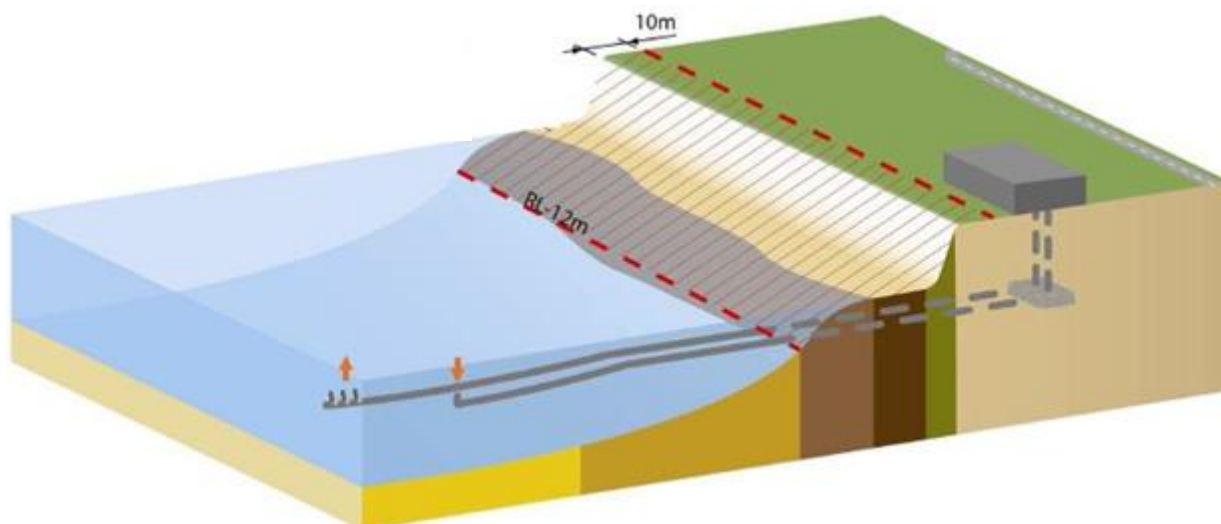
Immagine raffigurante un sistema di intake diretto sub-superficiale.
